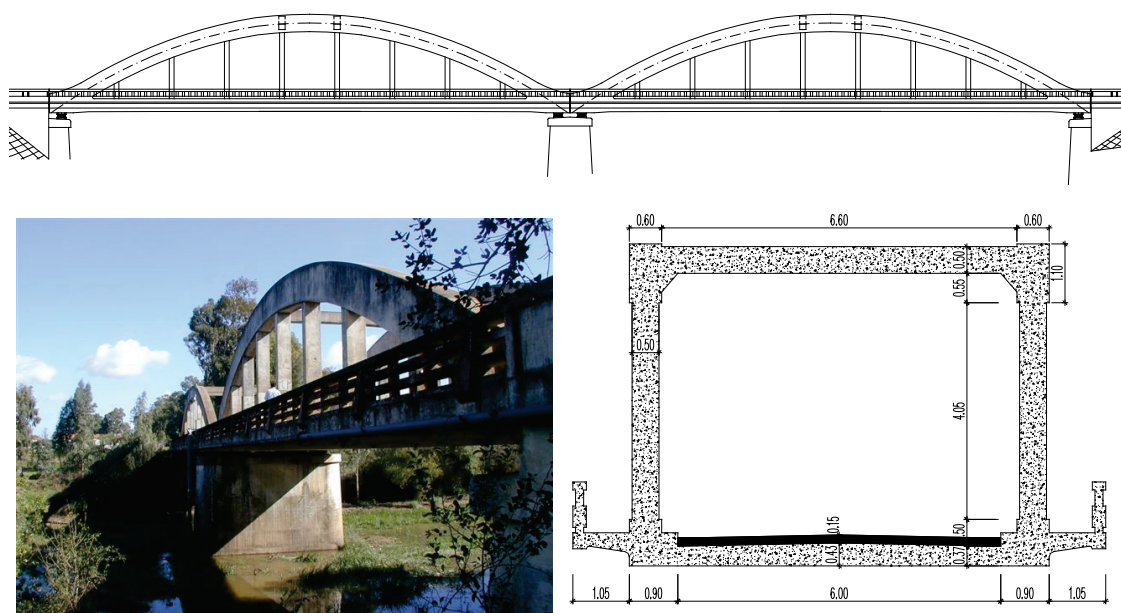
Ponte dos arcos – vista geral e secções longitudinal e transversal
